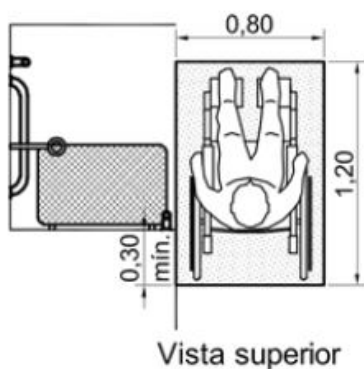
Área de transferência para boxe de chuveiro - exemplo.
